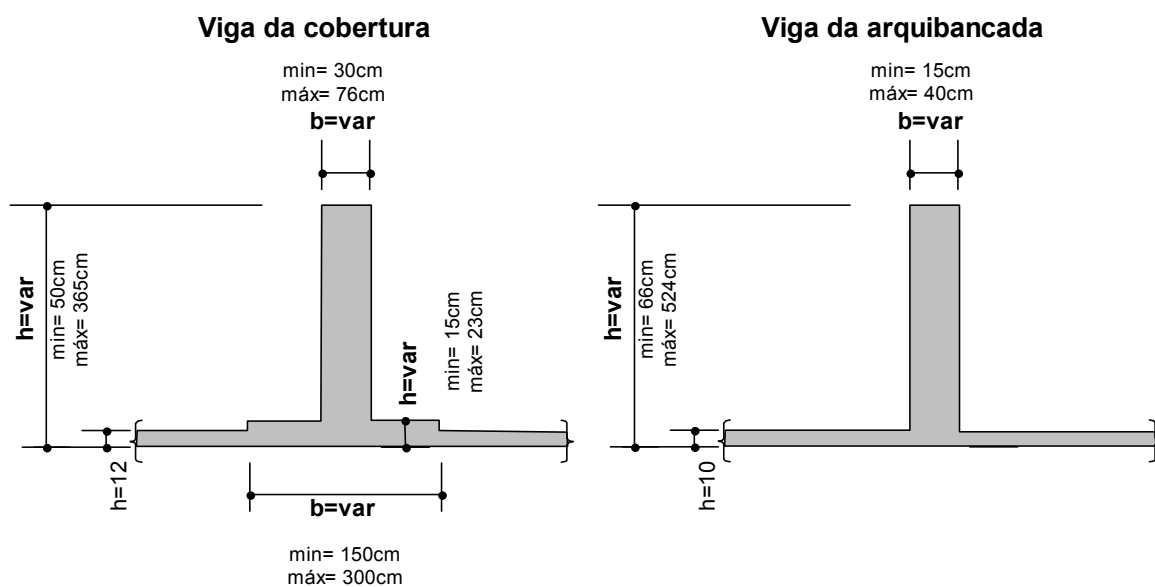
Croquis da seção transversal das vigas da cobertura e arquibancada
